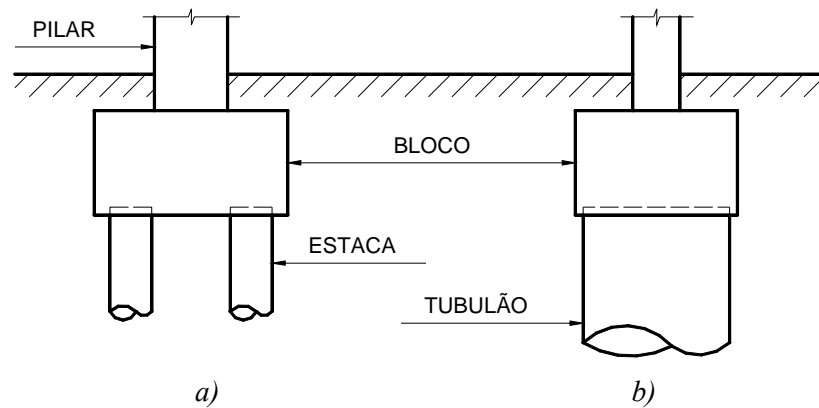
Bloco sobre: a) estacas e b) tubulão.
